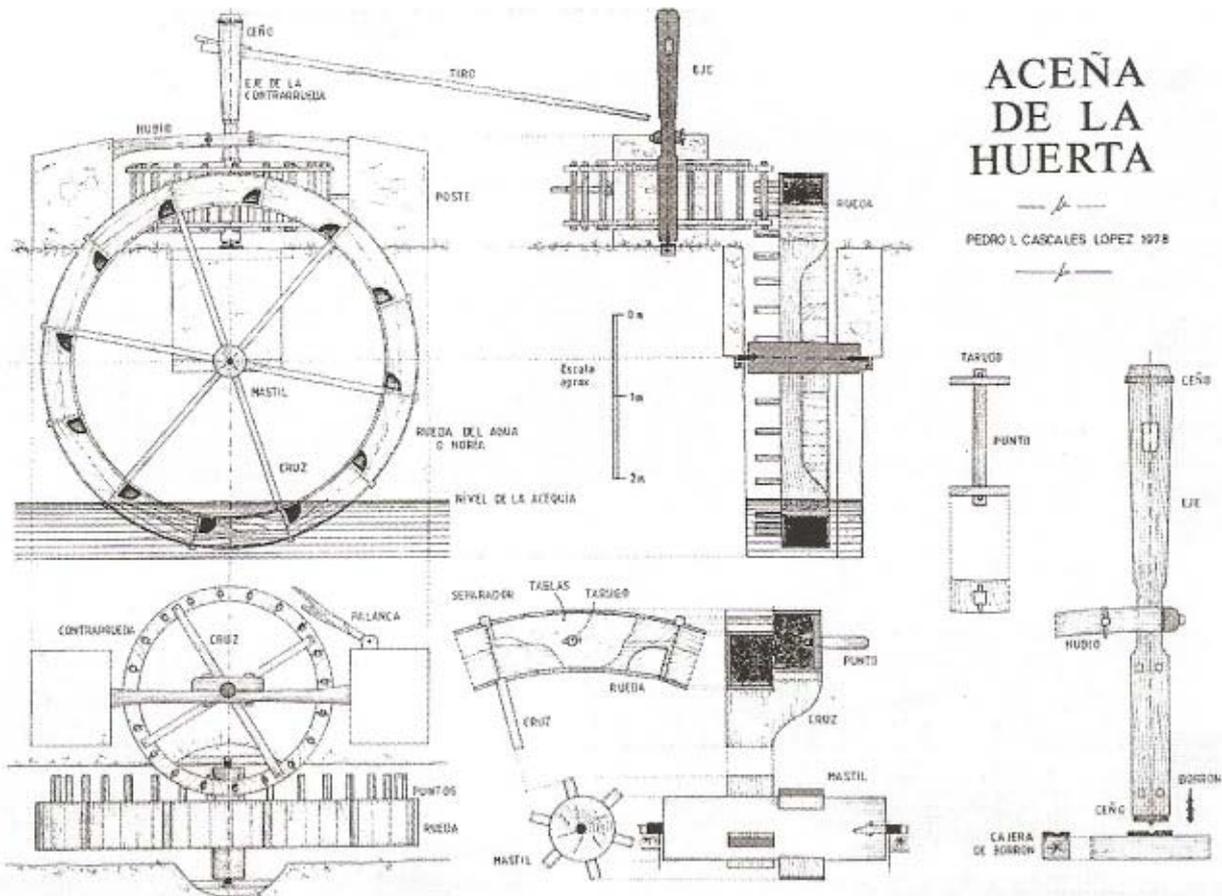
Planza, alzados y detalles de una aceña de la huerta de Murcia.
